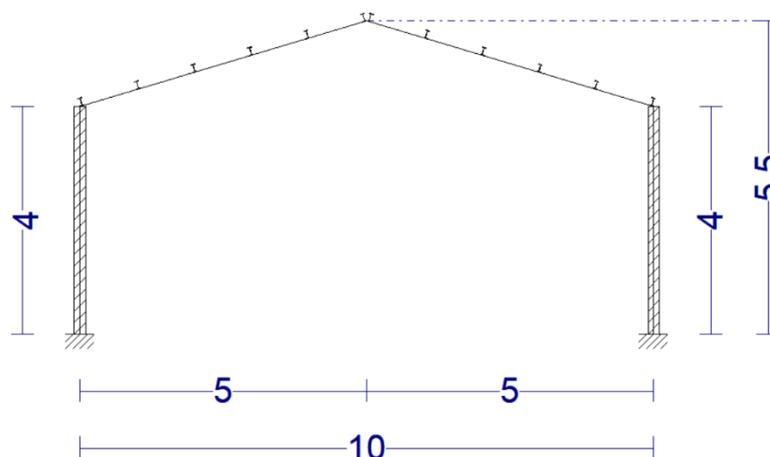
Pórtico frontal. (Fuente: elaboración propia a partir de Cype).
